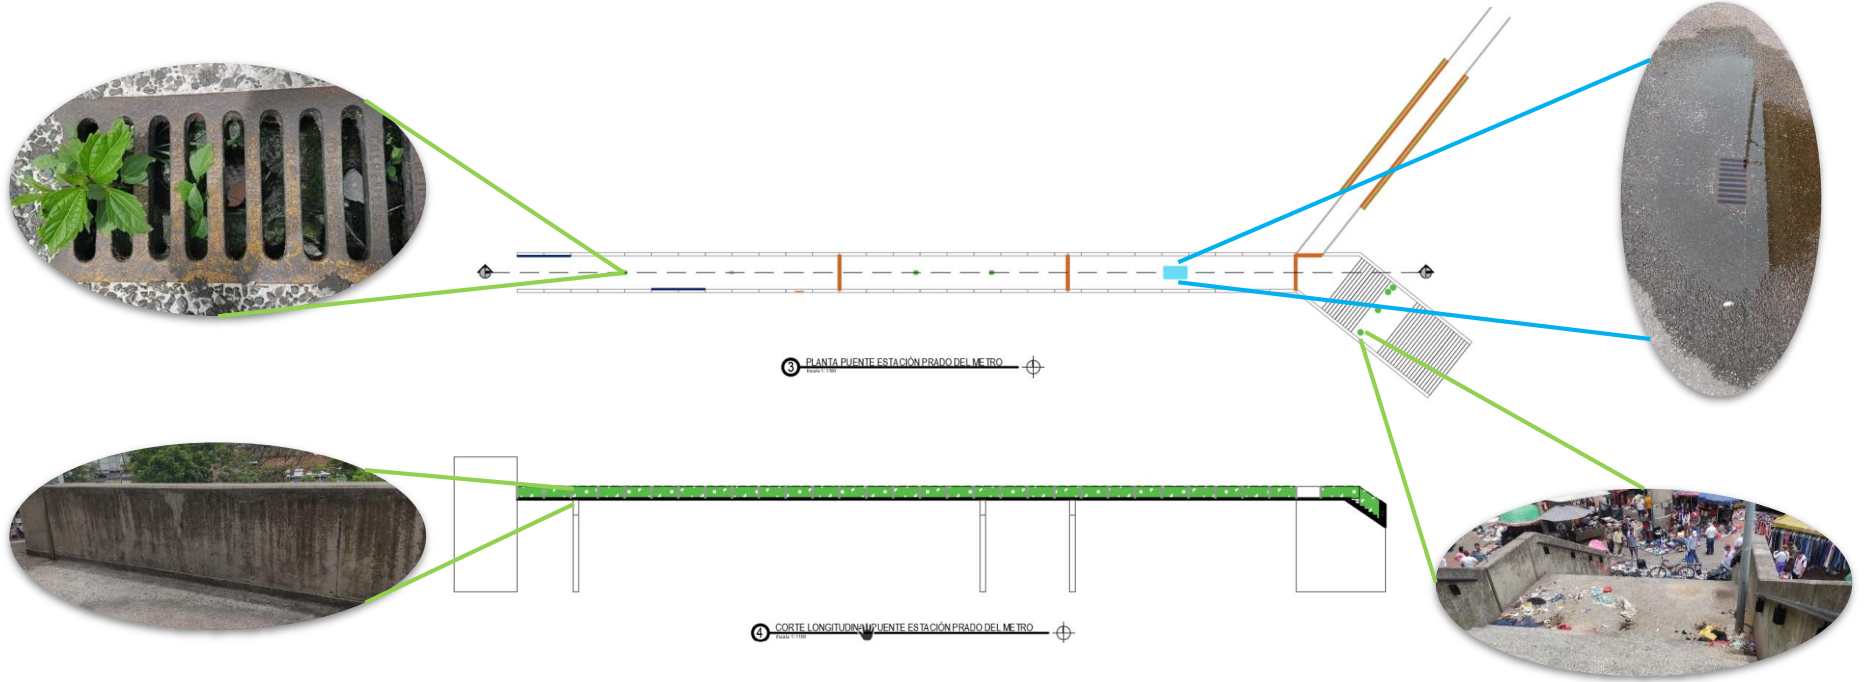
Plano en planta y corte del puente de acceso estación Cisneros del Metro
